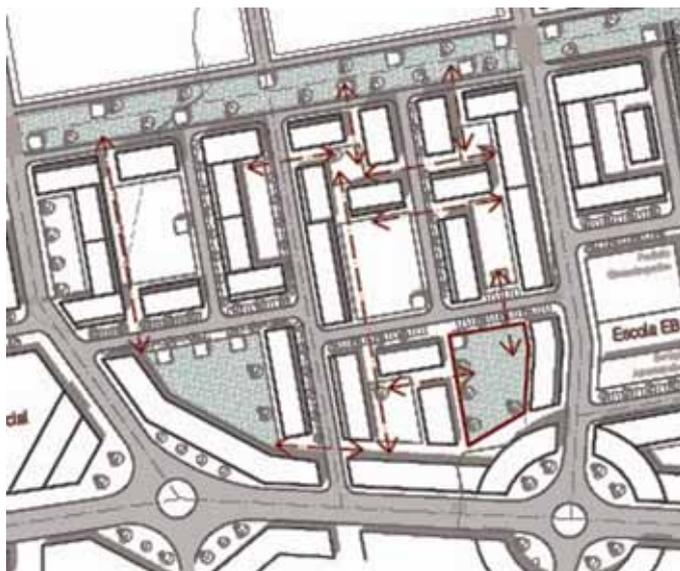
Plano de detalhe Redline – Planta com destaque para a distribuição de quiosques.
